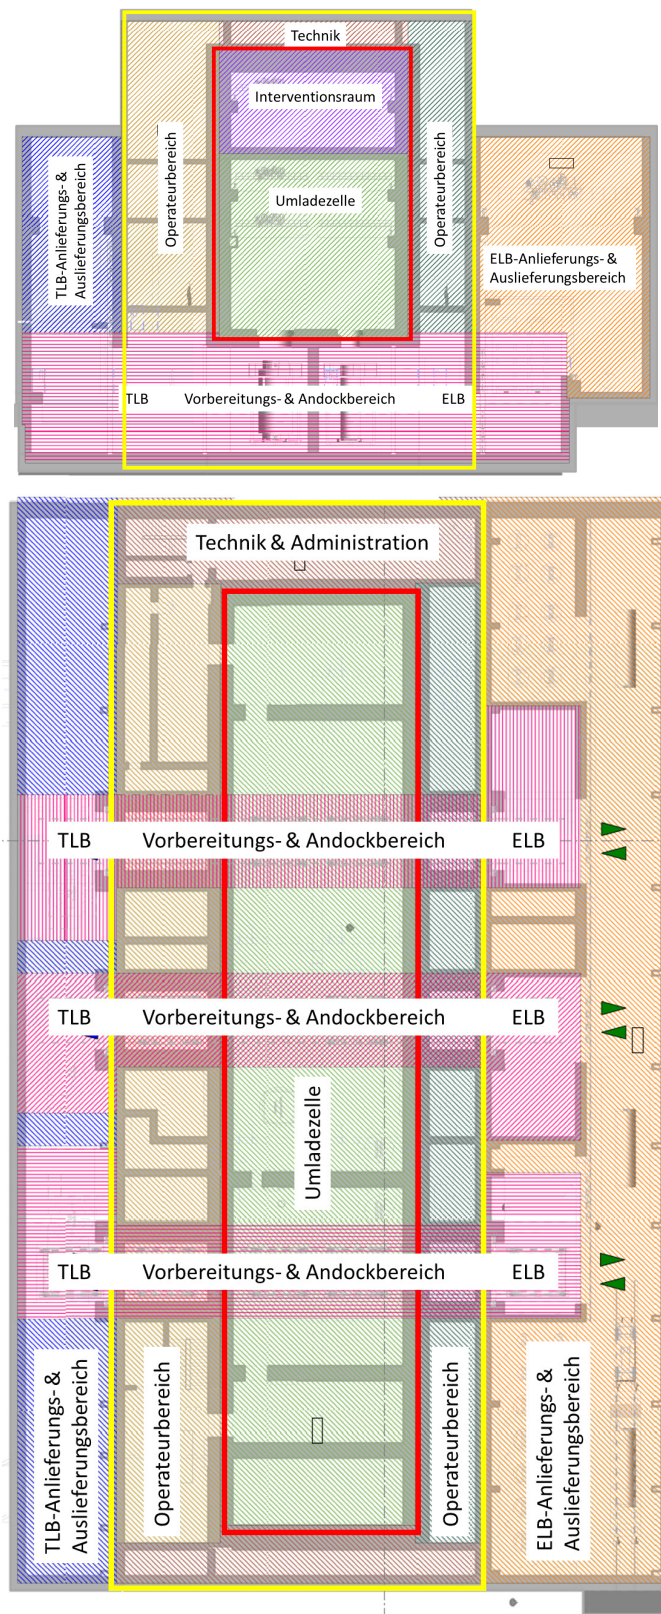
Querschnitt (oben) und Grundriss (unten) mit der Übersicht der wichtigsten Module einer BEVA
